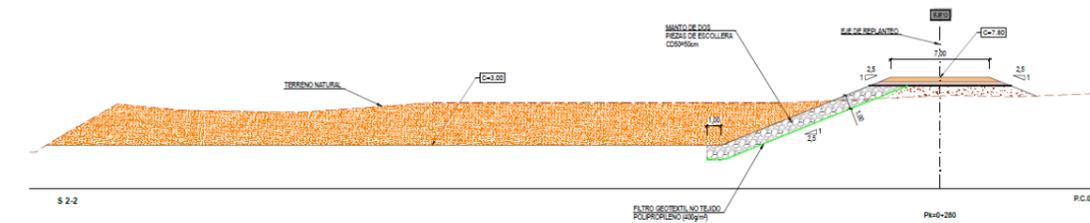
Sección tipo del recrecido de la mota de la M.I. con protección de escollera
